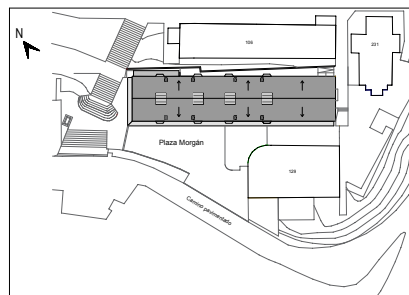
Emplazamiento edificio N°125, Base planimétrica, Fundación Sewell (fuente: Elaboración propia, 2019).
